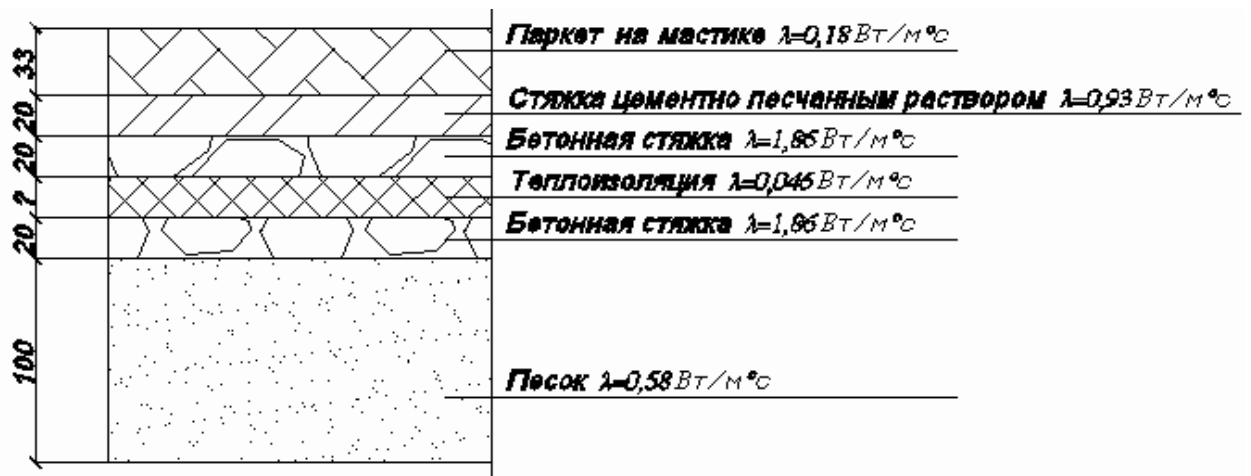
Расчетная схема конструкции полов на грунте
